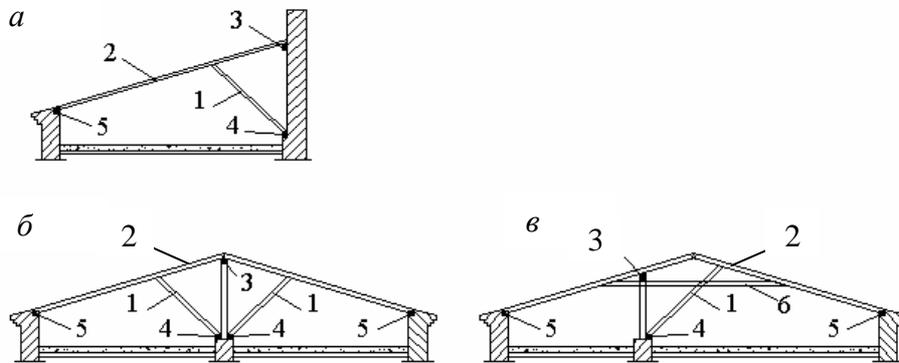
Последовательность разборки (1 – 6) наслонных стропил крыш различной конструкции: а, б – односкатной и двускатной с симметрично расположенной стеной; в – двускатной с несимметрично расположенной средней капитальной стеной; 1 – подкос; 2 – стропильная нога; 3 – верхний прогон; 4 – лежень; 5 – мауэрлат; 6 – затяжка
